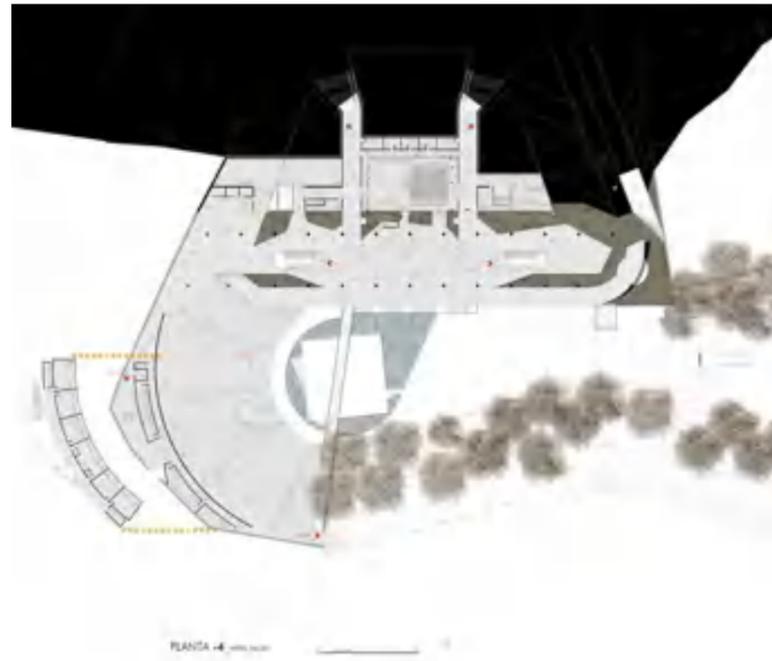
Planta Nivel -4. FONTE: *Archdaily*.
